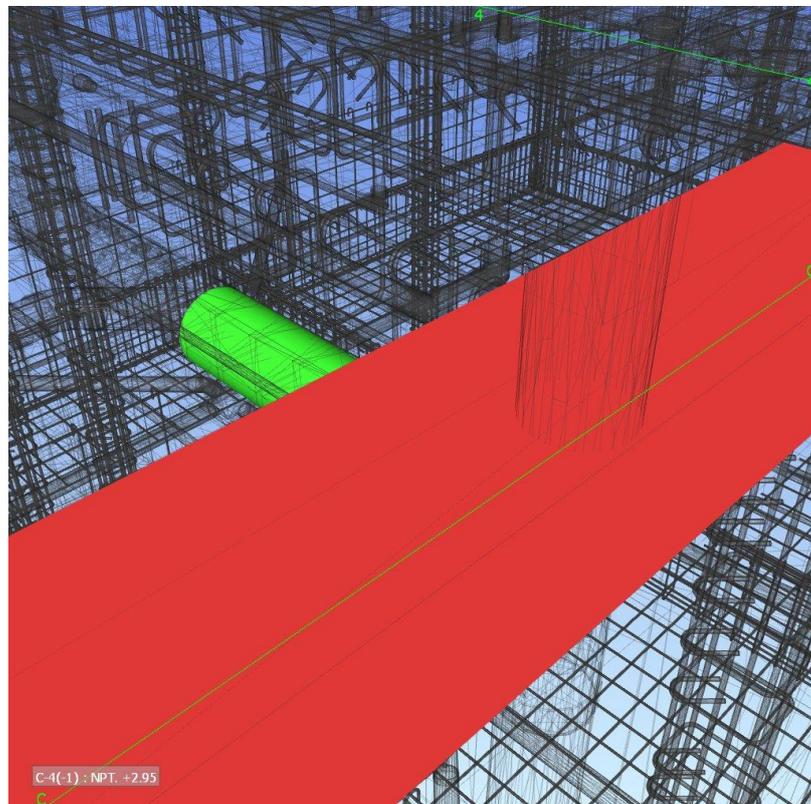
Interferencia entre Sobrecimiento Armado y Tubería de desagüe
